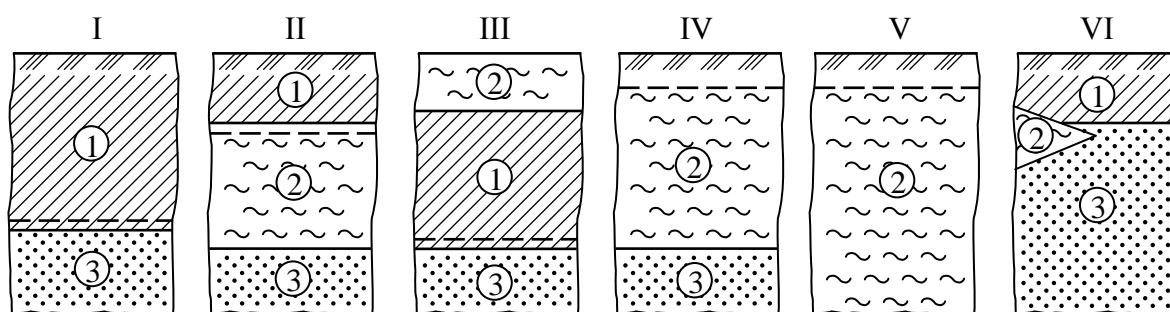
Схеми типових напластувань ґрунтів (I–VI):
